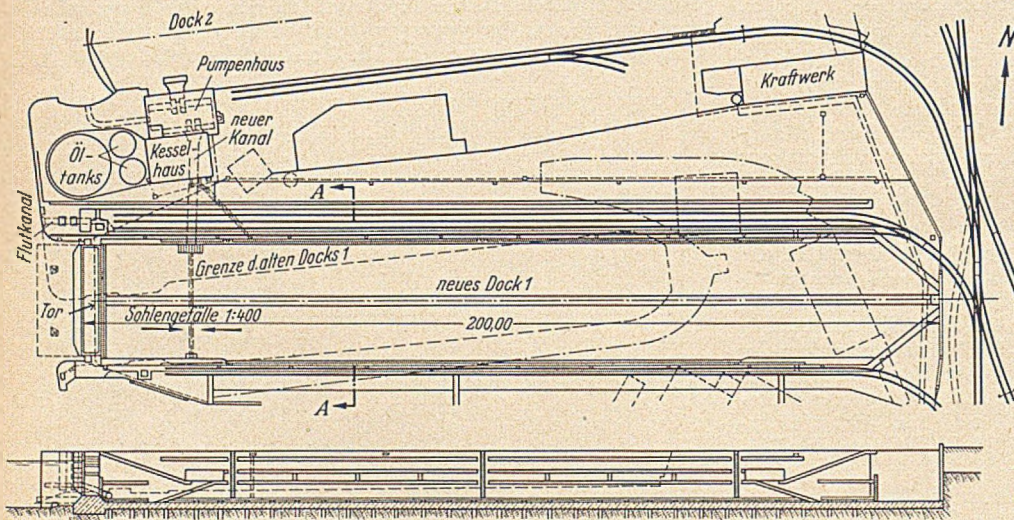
Plan des umgebauten Docks 1 und Längsschnitt.
